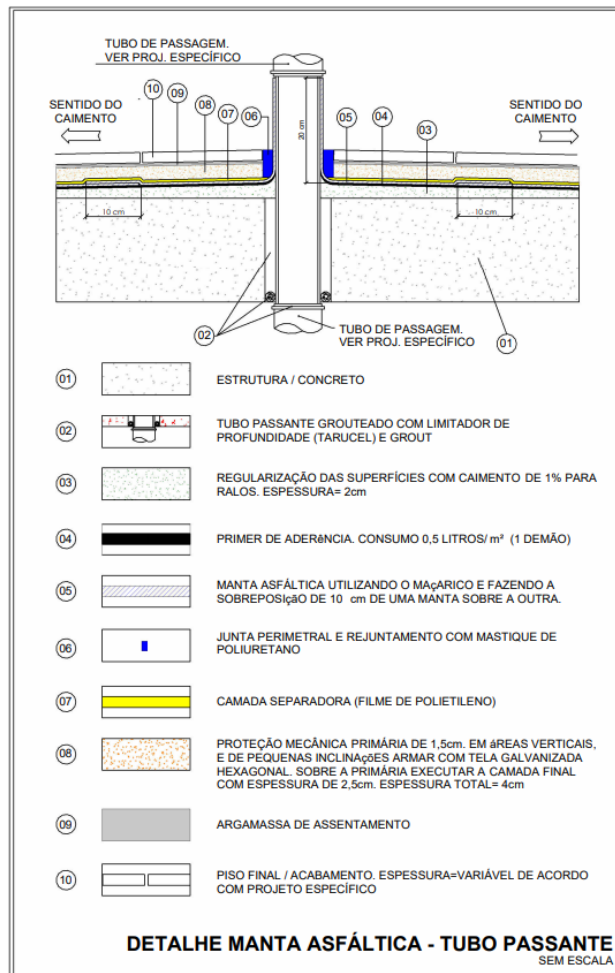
Detalhe de Impermeabilização com Manta Asfáltica para Tubo Passante
